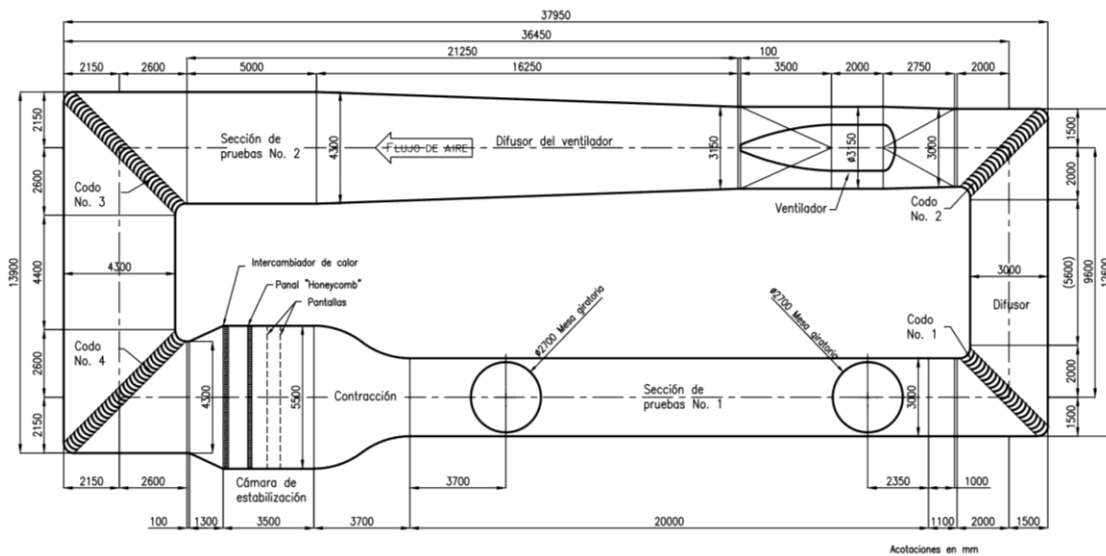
Plano en planta del túnel de viento (II UNAM)
